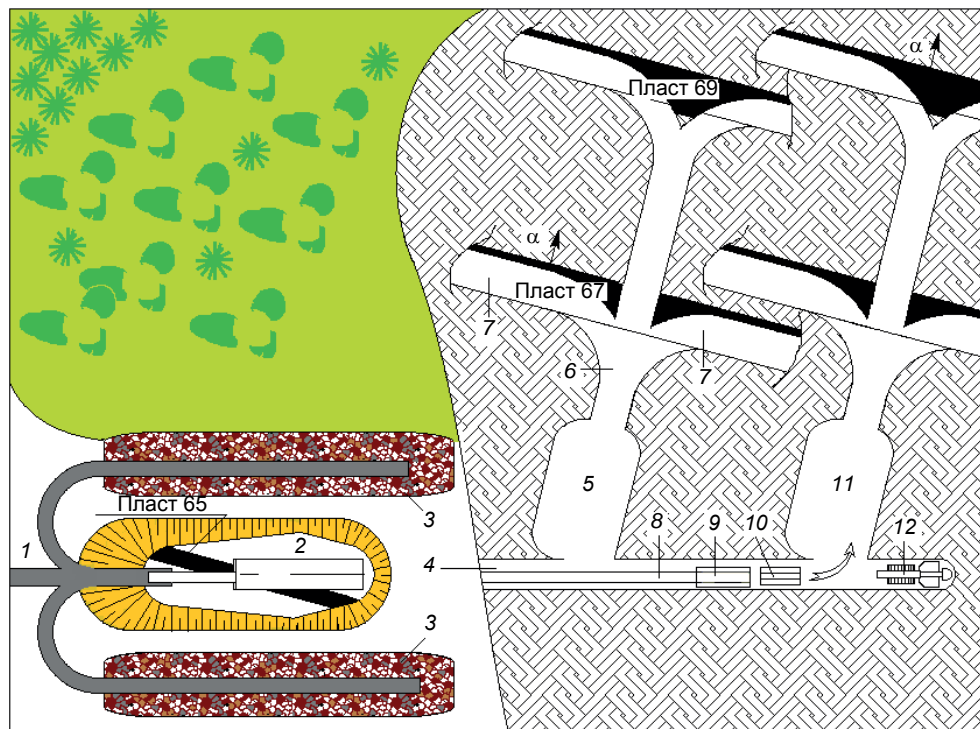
Схема вскрытия, подготовки и отработки свиты угольных пластов (вид в плане). 1 – рабочая площадка; 2 – разрезная траншея; 3 – внешний отвал; 4 – наклонная выработка; 5 – слоевая камера I; 6 – квершлаг; 7 – выемочная камера; 8 – ленточный телескопический конвейер; 9 – бункер-перегрузочный; 10 – самоходный вагон; 11 – слоевая камера II; 12 – комбайн избирательного действия / Figure 4. Scheme of opening, preparation and mining a formation of coal seams (plan view).
